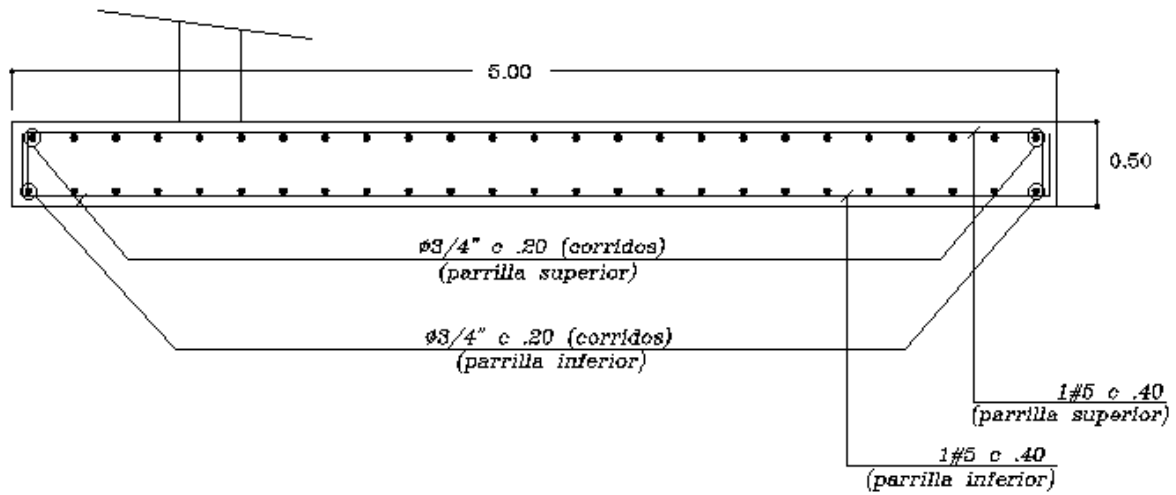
Sección transversal de dado- zapata de estribo (elaboración propia).
